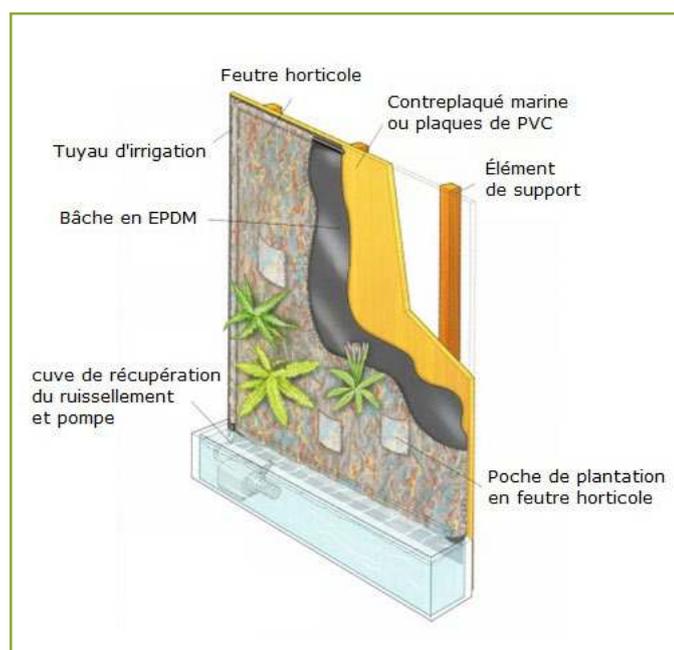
schéma en coupe d'un mur végétal sur nappe continue. Source : J.-M. Grout.
